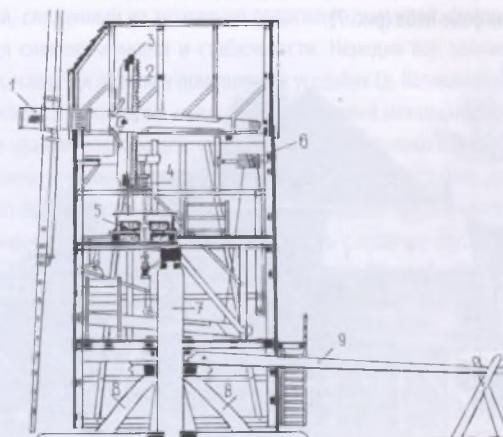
Разрез ветряной мельницы козлового типа из Домотканович: 1 — вал; 2 — зубчатое колесо; 3 — тормозной «хомут»; 4 — зубчатая шестерня; 5 — жернова; 6 — блок для подъема мешков с зерном; 7 — осевой столб; 8 — козловая опора; 9 — брус для поворота мельницы («дышель»)
